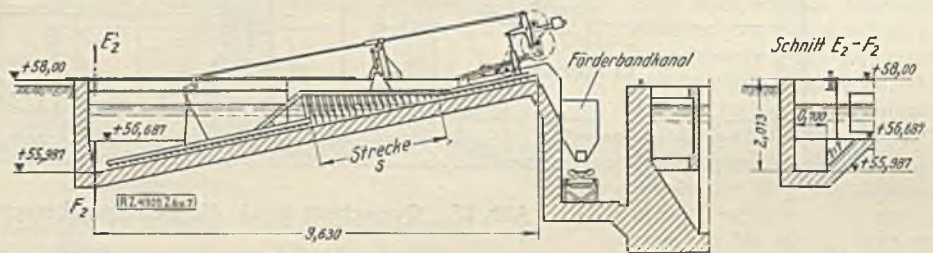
Längsschnitt durch den Klassierer des nördlichen Sandfanges.
